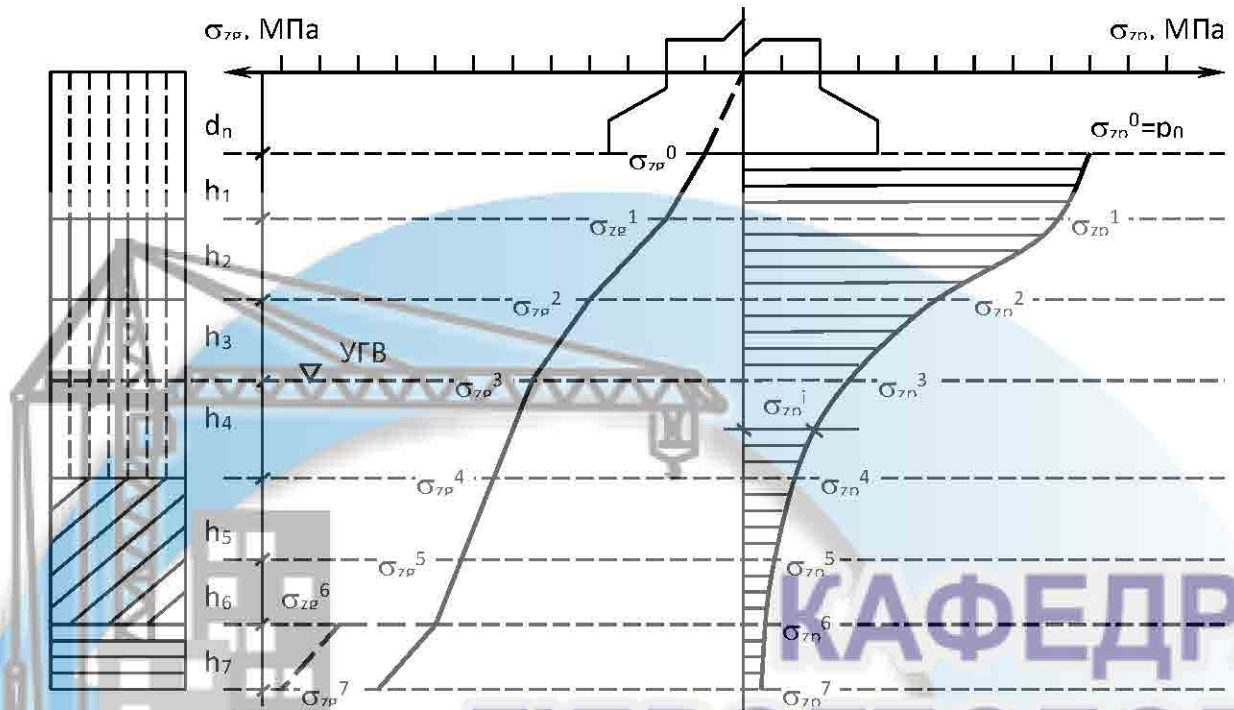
Схема до розрахунку осідання фундаменту з епоруєю напружень
